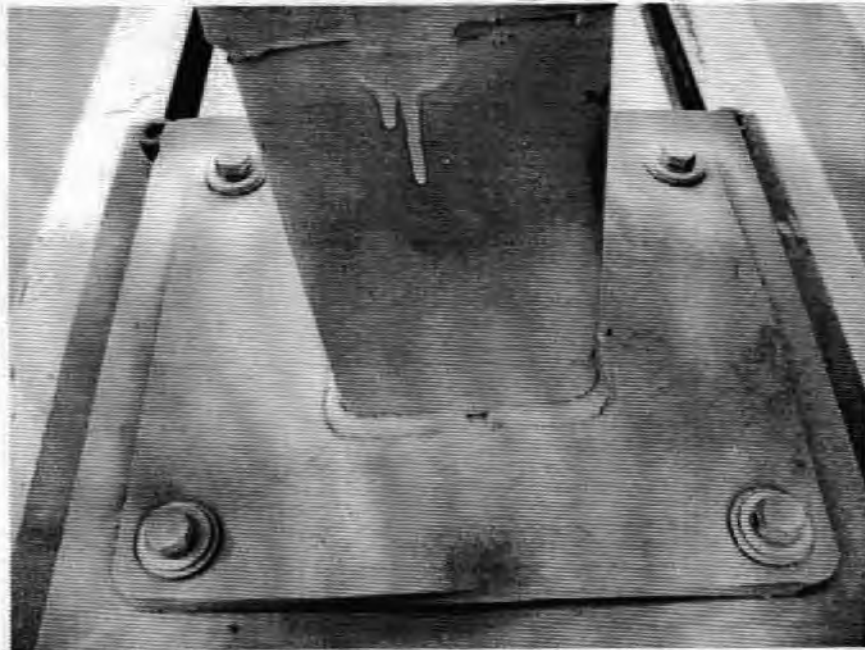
VISTA LATERAL DA BASE DE FIXAÇÃO APÓS O TESTE.
